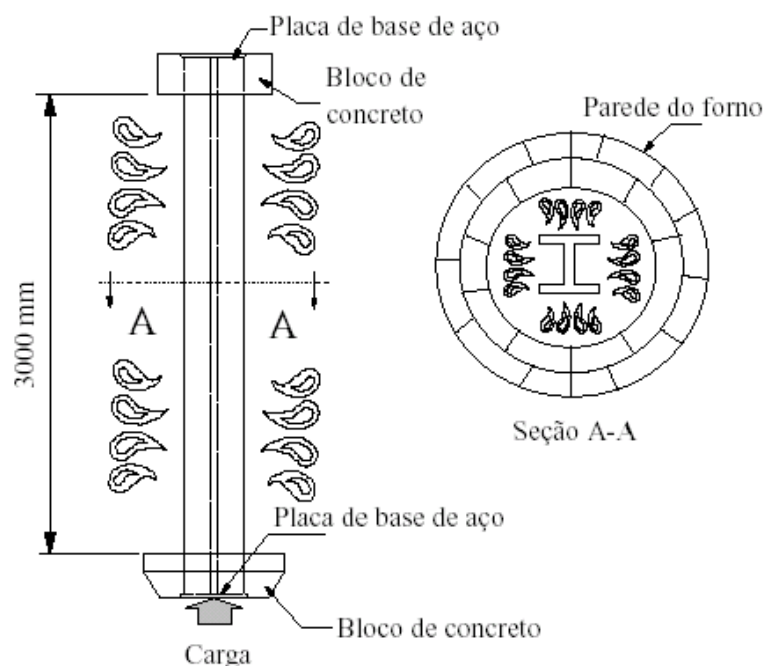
Esquema do ensaio-padrão de pilares.
